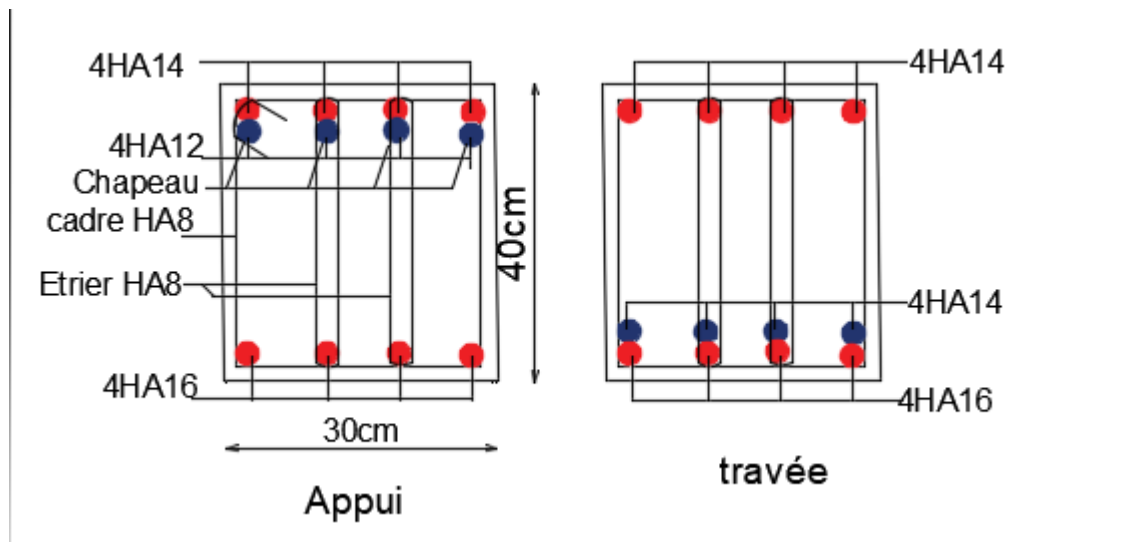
Schéma de ferrailage de la poutre principale du plancher étage 1
